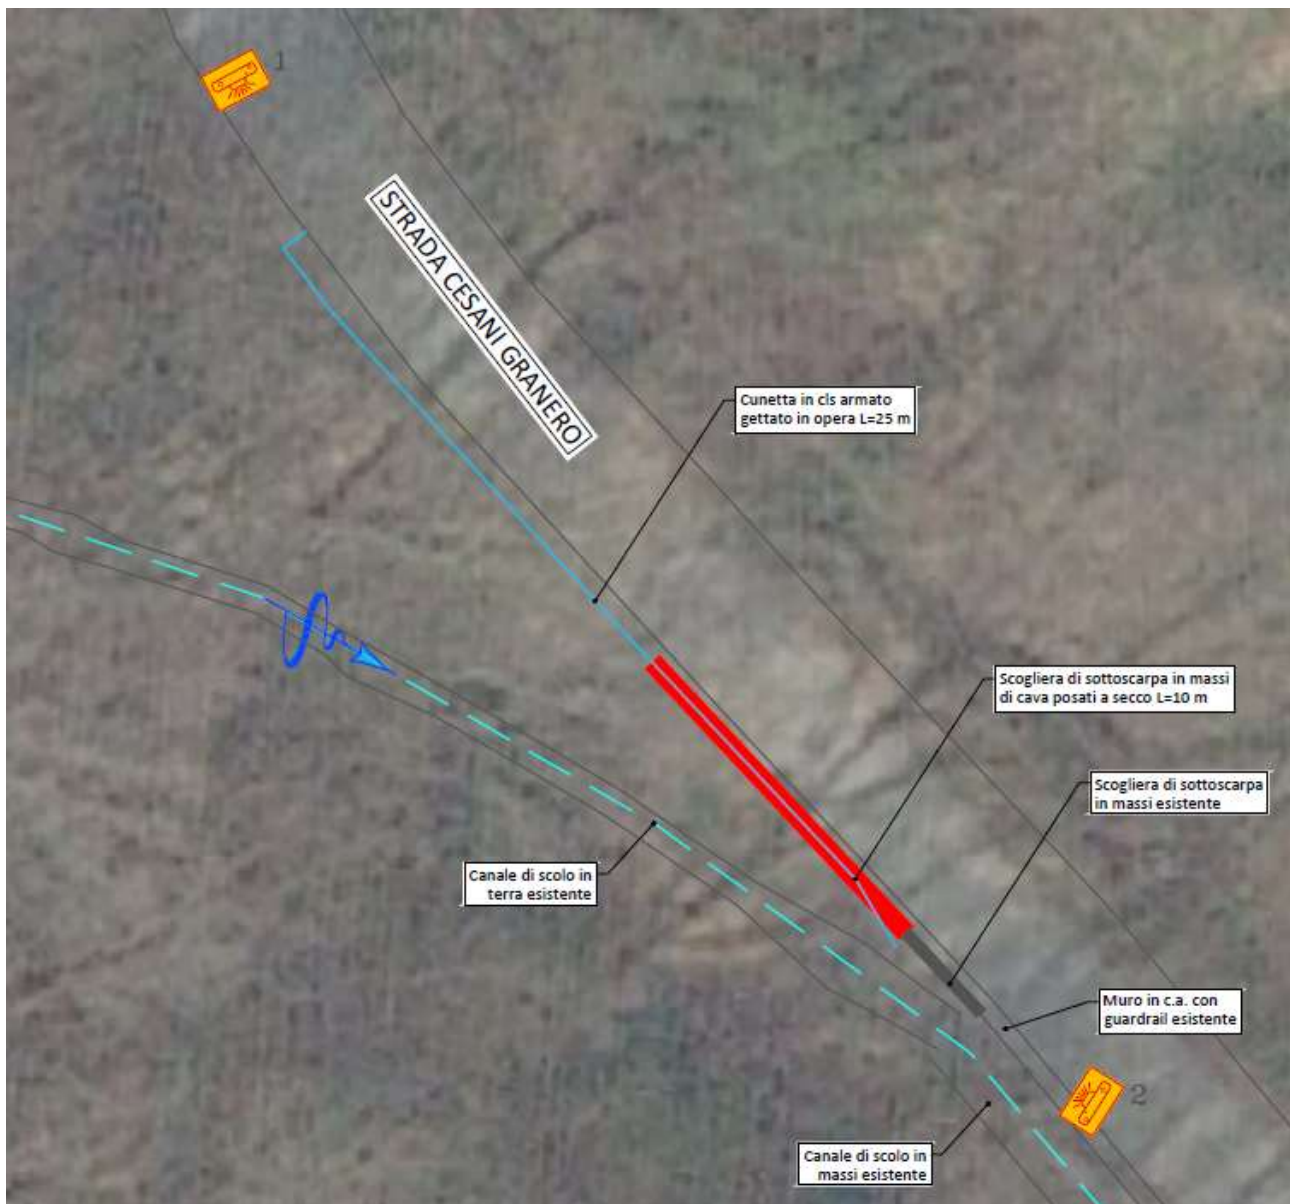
Estratto\_Planimetria\_progetto\_Strada\_Cesani granero
